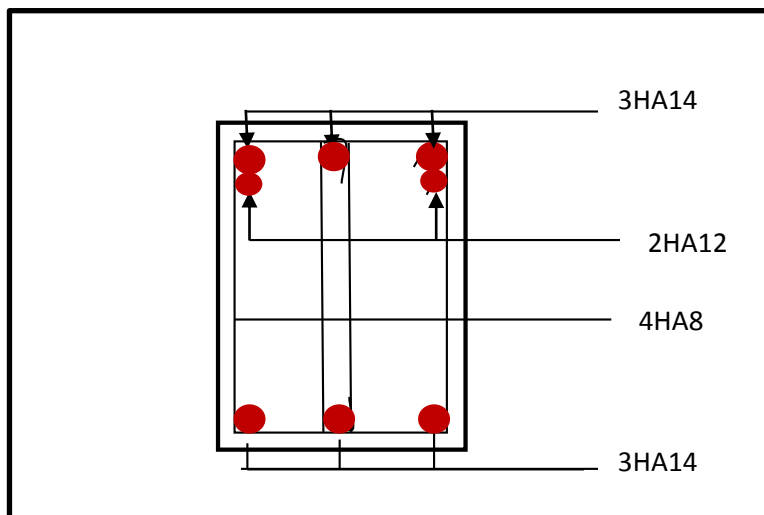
Ferrailage sur appuis d'une poutre principal
